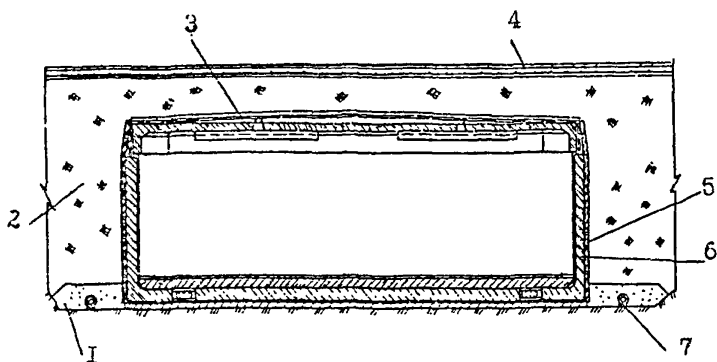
Схема дренажа подземных пешеходных переходов:
